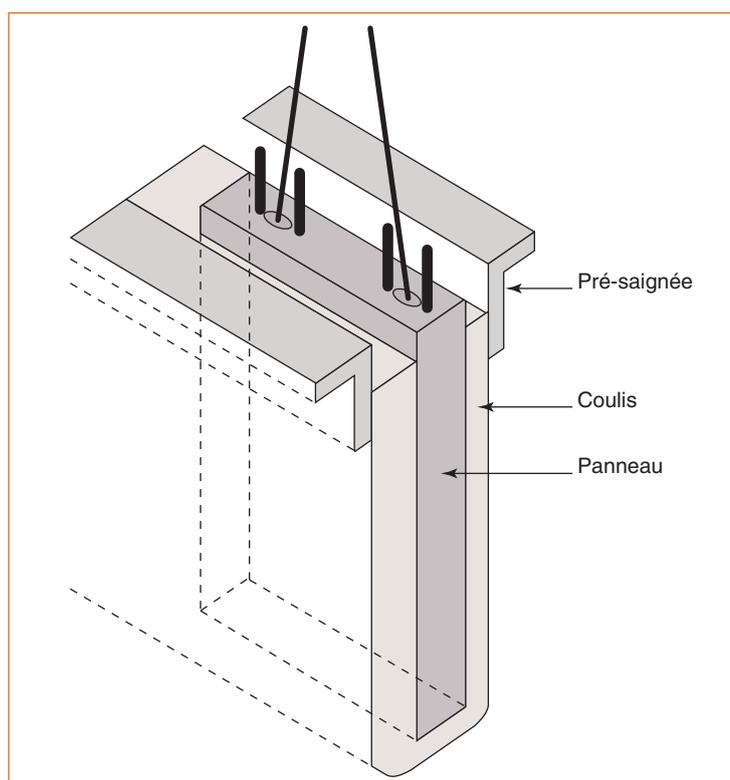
Principe de construction d'une paroi préfabriquée.
